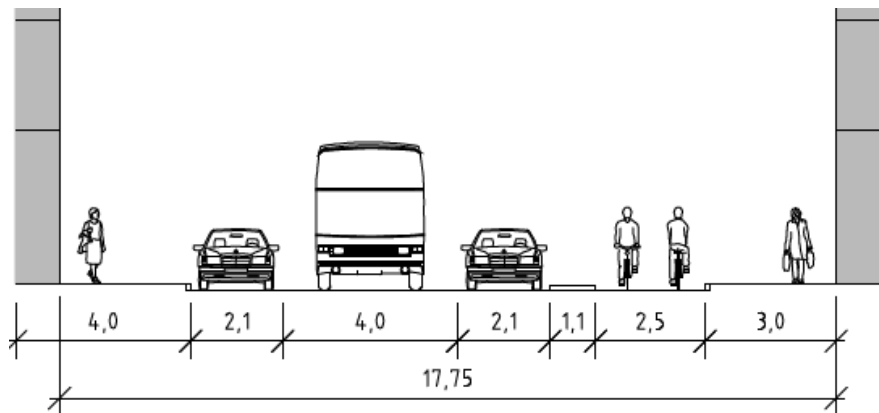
Föreslagen sektion och plan på sträckan mellan (Valhallavägen), Lill-Jans plan (i norr) och Östermalmsgatan (i söder)
